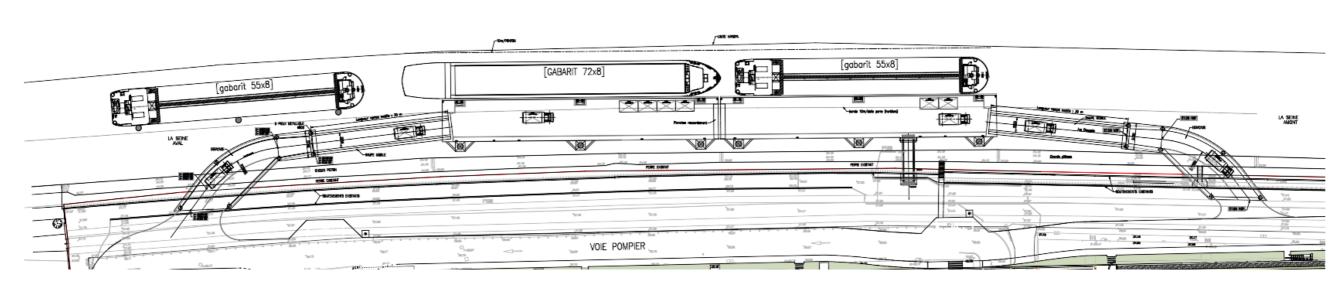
Plan de masse du ponton (Source: Ship-ST)
